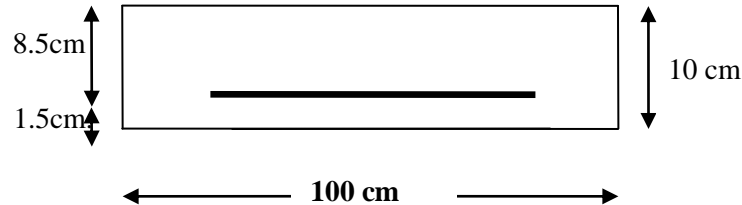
section de calcul d'acrotère de la terrasse inaccessible.
